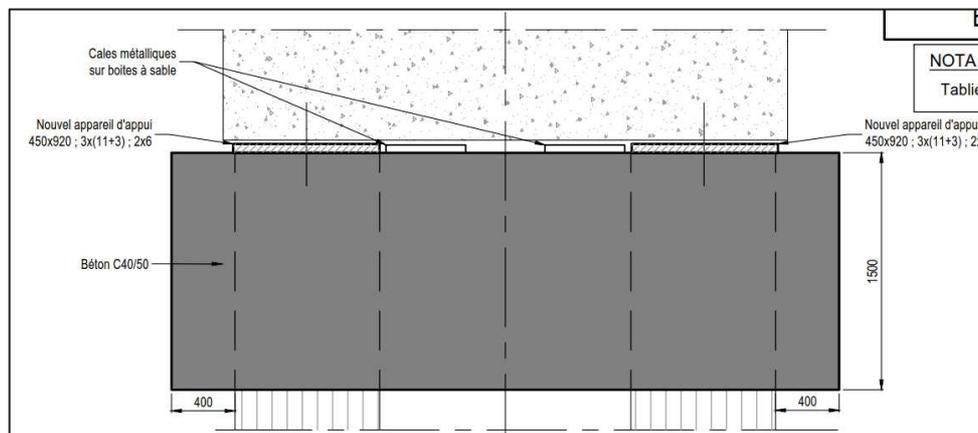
Extraits du plan de renforcement en têtes de piles (source : Arcadis MOE PRO)
